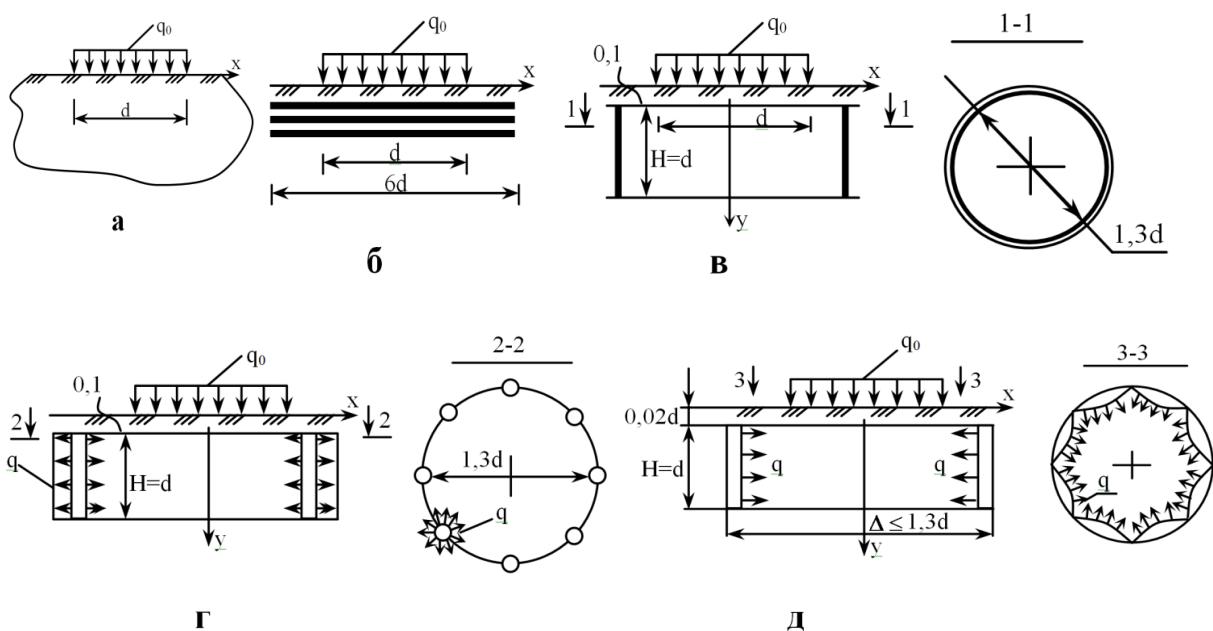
Схемы армирования грунтового основания под здания и сооружения:
